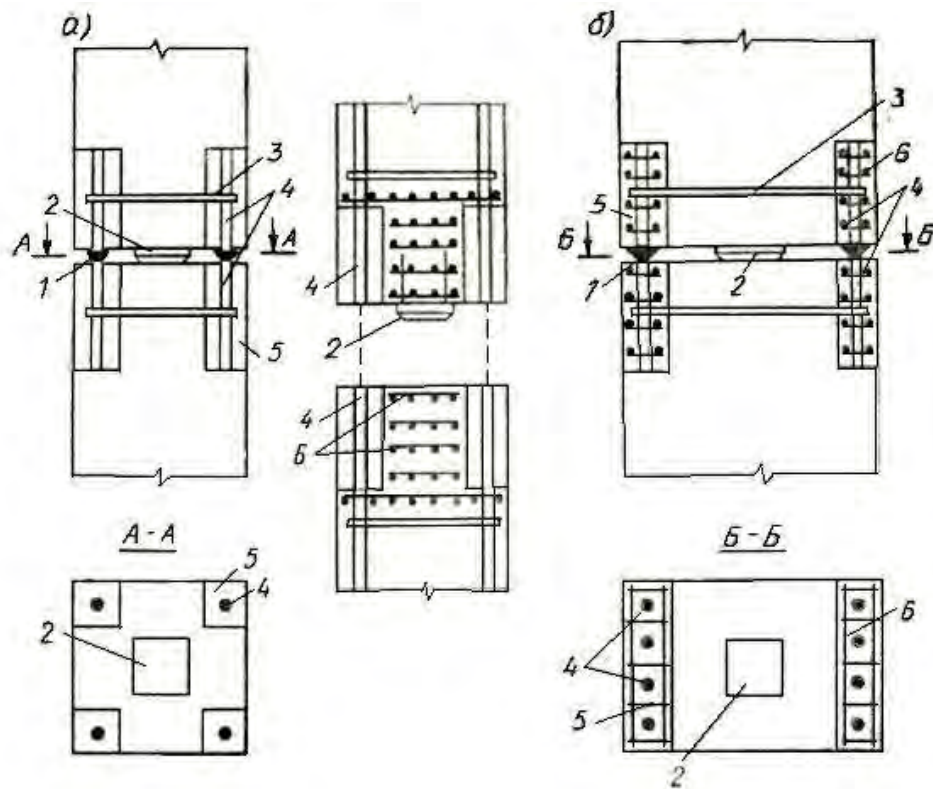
Конструкция жесткого стыка колонн с ванной сваркой арматурных выпусков
